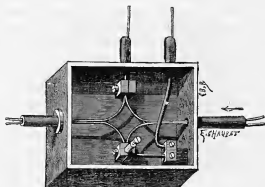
Branchement sur la conduite principale d'électricité dans le système Edison.
